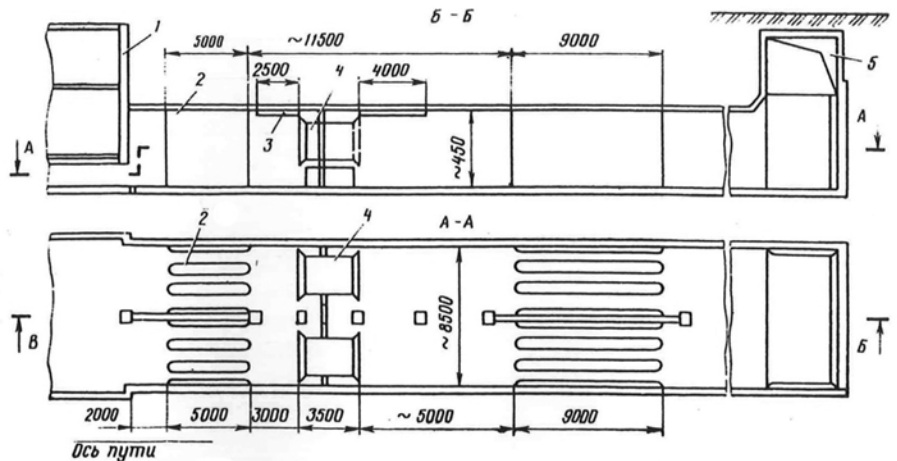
Вентиляционная установка на мелко заложённых станциях: 1 — торец станции; 2 — шумоглушительные перегородки; 3 — монтажные балки; 4 — вентиляторы; 5 — вентиляционный канал, ведущий к киоску
